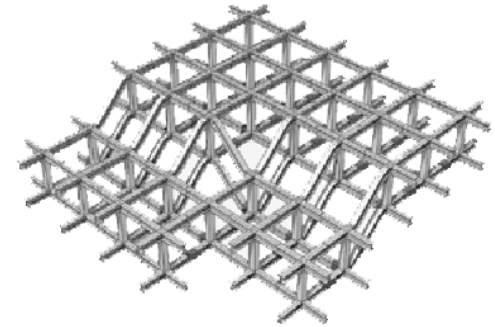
Constructieve structuur van stalen kolommen in de zuid façade.
